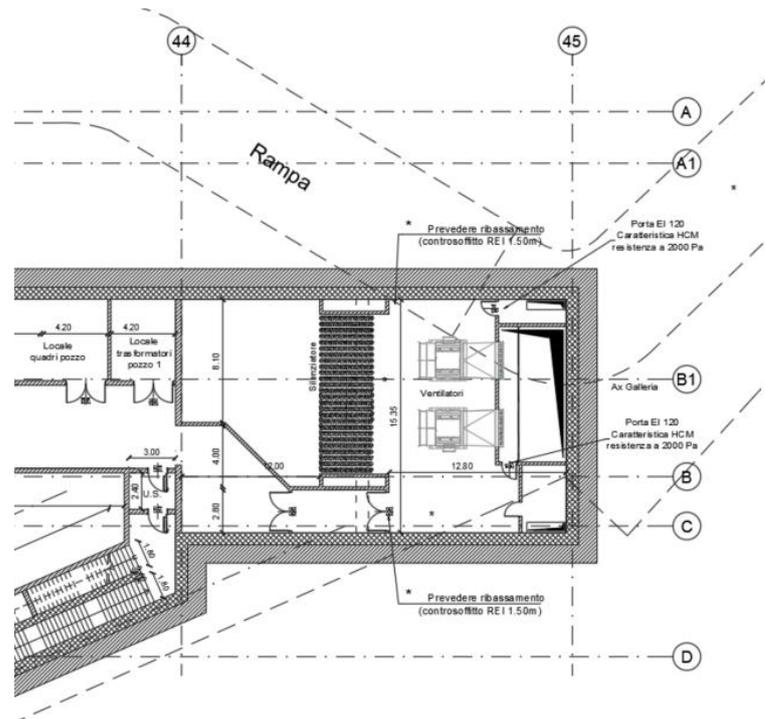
Pozzo Rebaudengo – Camera di ventilazione
